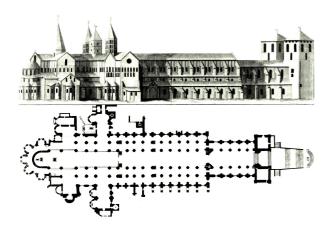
Planta y alzado de la Abadía de Cluny, Cluny.
